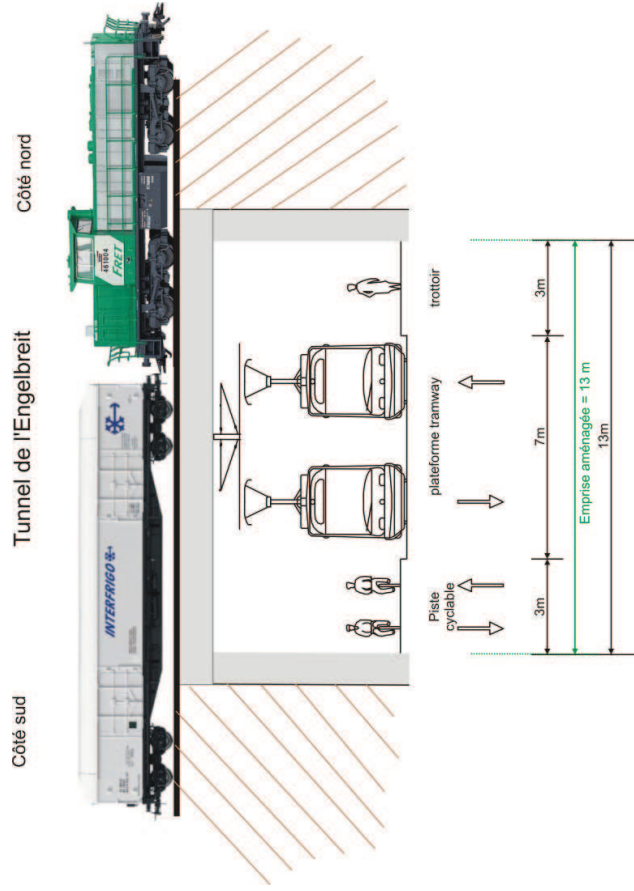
Aménagement proposé - coupe 8 (tunnel de l'Engelbreit)
